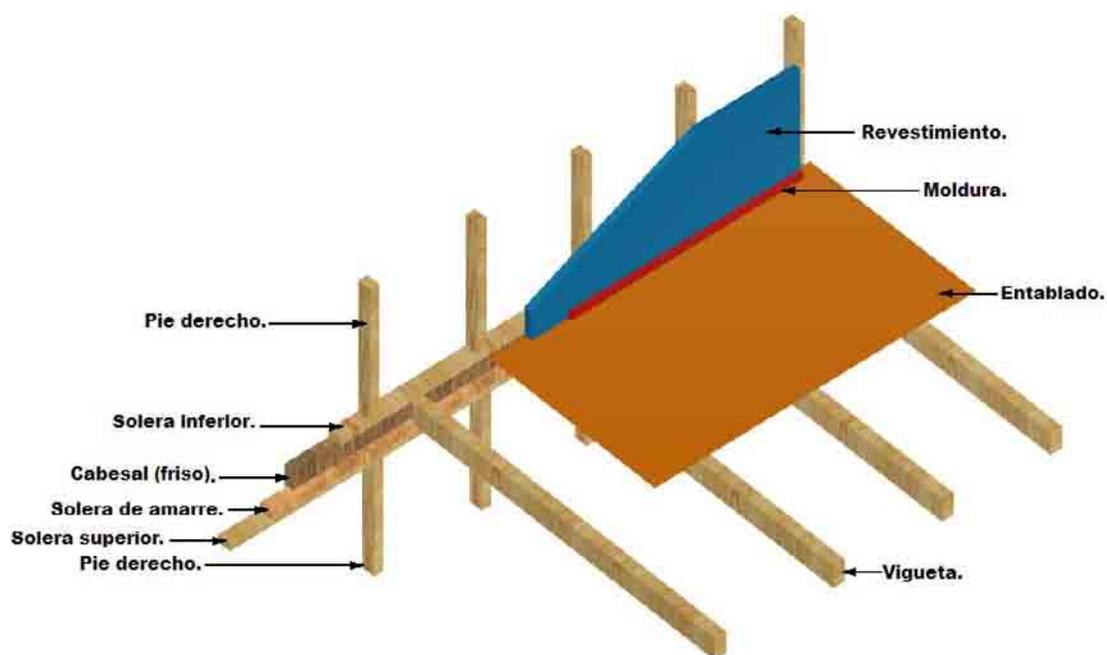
Esquema explicativo colocación materiales. Fuente: Elaboración propia.
